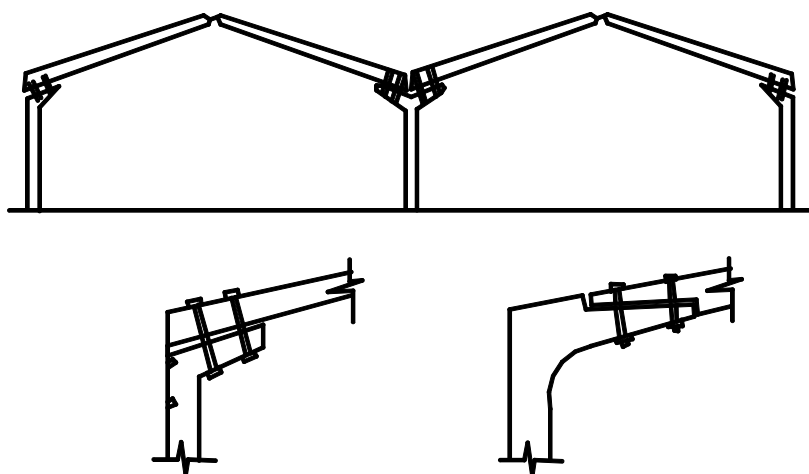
Універсальна конструкція каркасу із збірних залізобетонних елементів з вузловими з'єднаннями на болтах (Англія)
